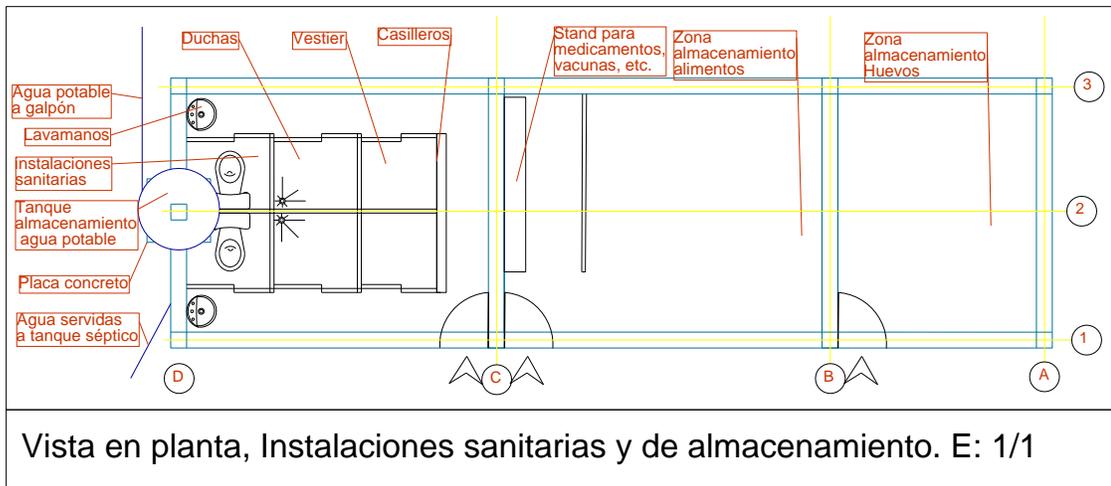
Plano vista en planta de instalaciones sanitarias y bodegas
